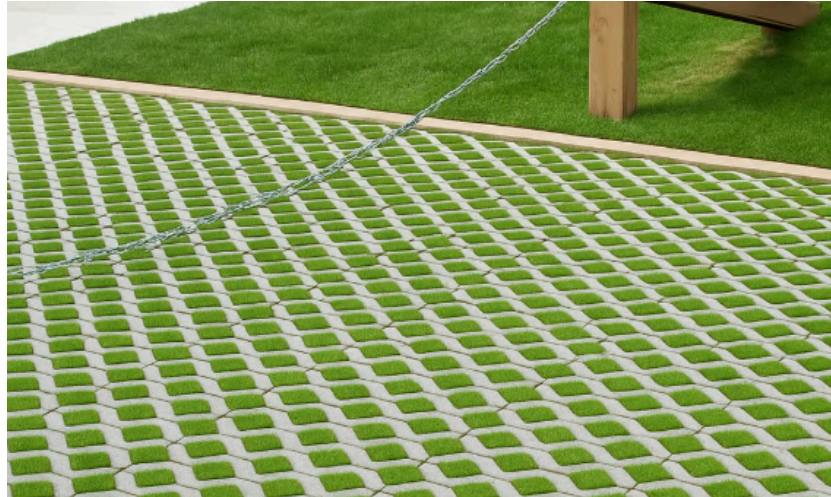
Pavimento intertrabado verde - Dársena de estacionamiento. Fuente: Concretus.
